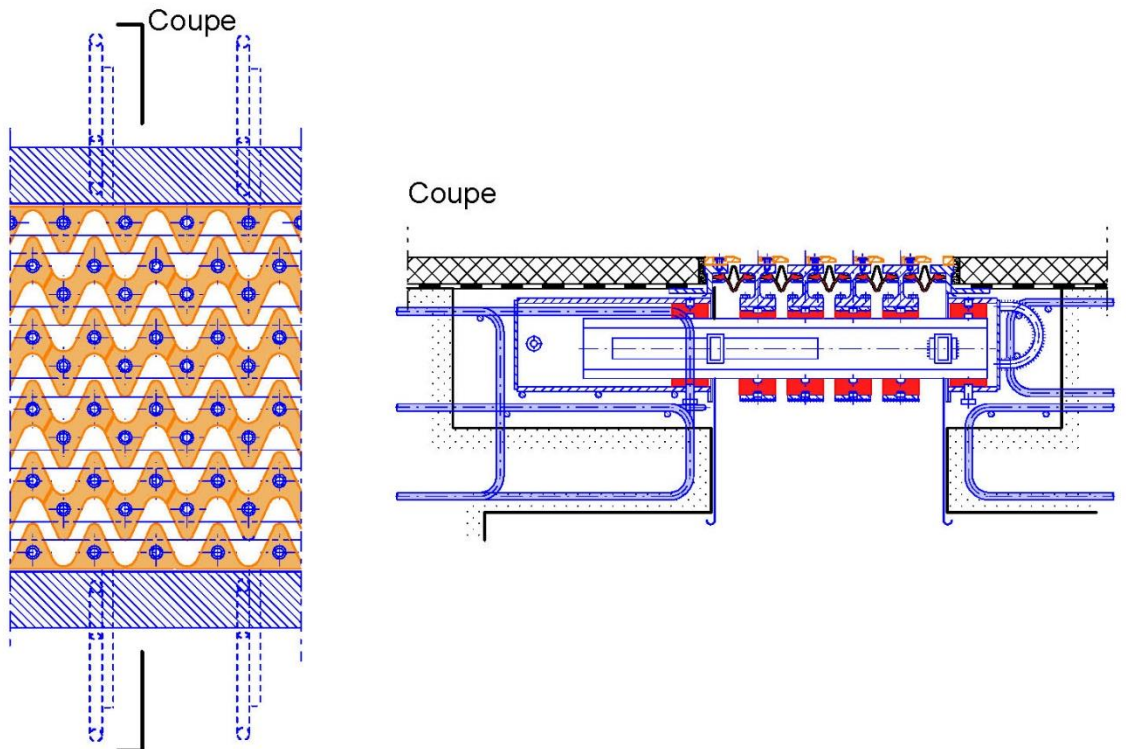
Vue d'en dessus et coupe schématiques d'un joint de chaussée à plusieurs profilés compressibles et plaque sinusoïdale.
